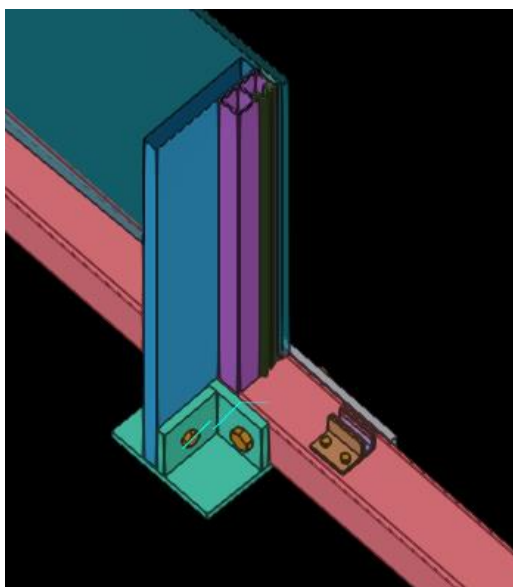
Pormenores construtivos usados no Teatro do Jordão.
